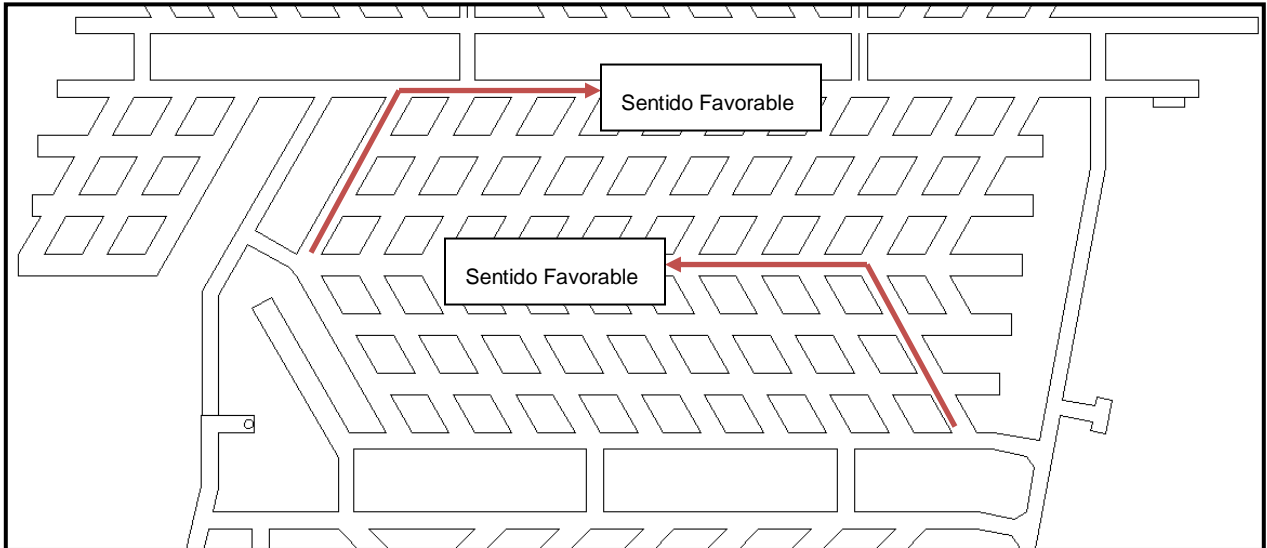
Layout unidad 15E bajo extracción modular de sub-paneles.
